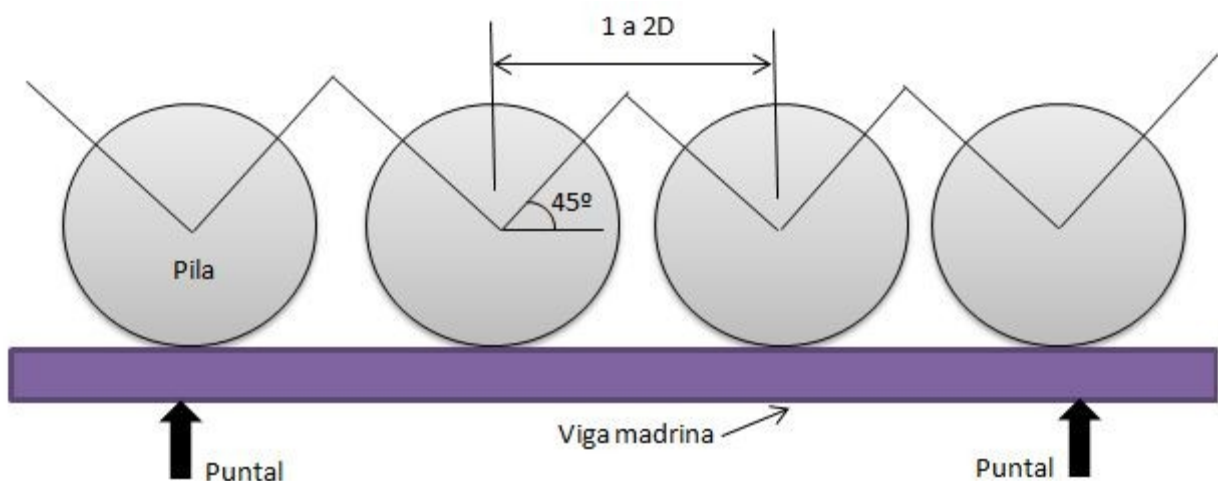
Esquema de la primer variante de pilas secantes.
